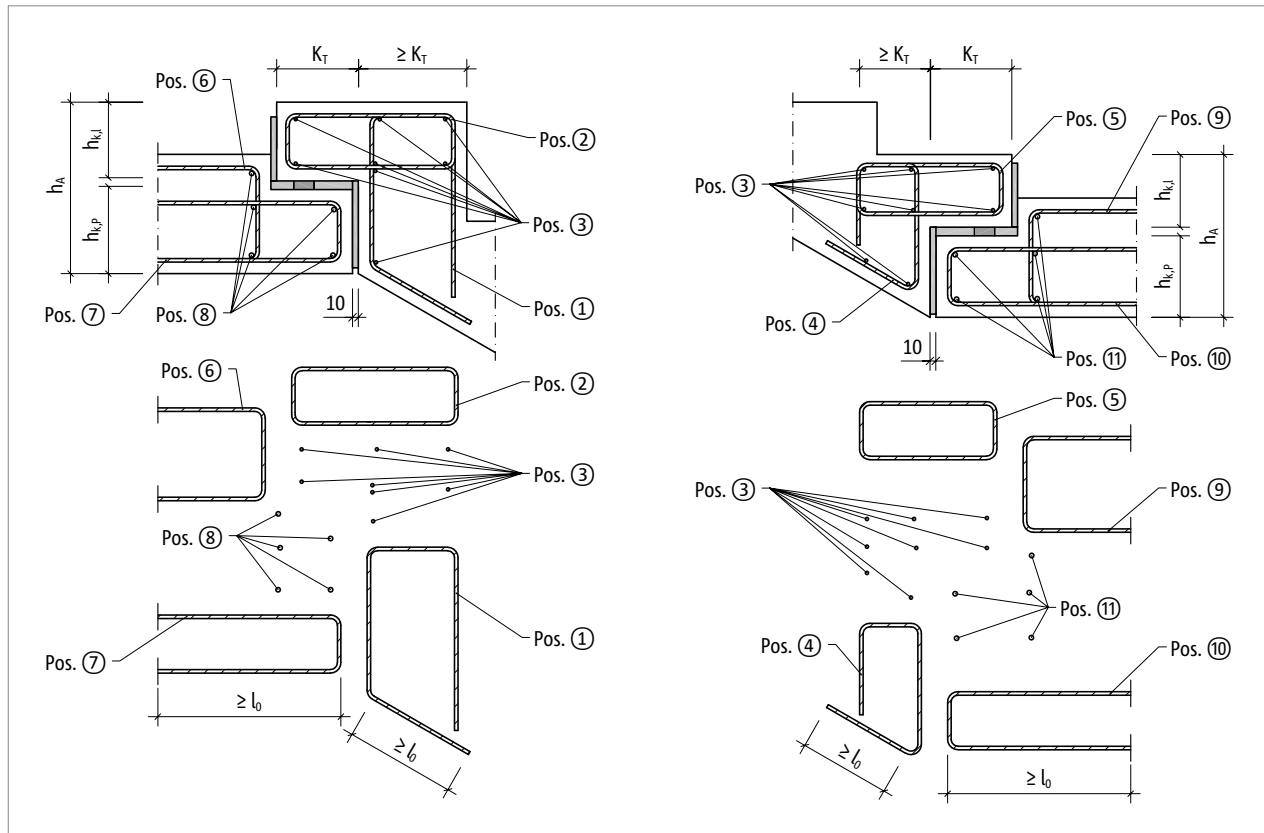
Schöck Tronsole® Typ BZ: Bauseitige Bewehrung bei Konsolanschluss
